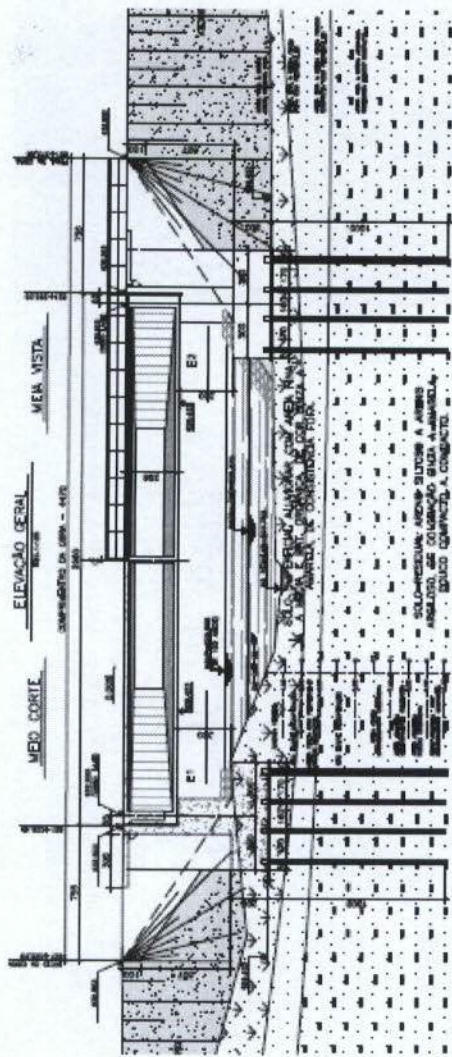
Projeto da ponte sobre o Riacho sem denominação I (elevação em corte)
